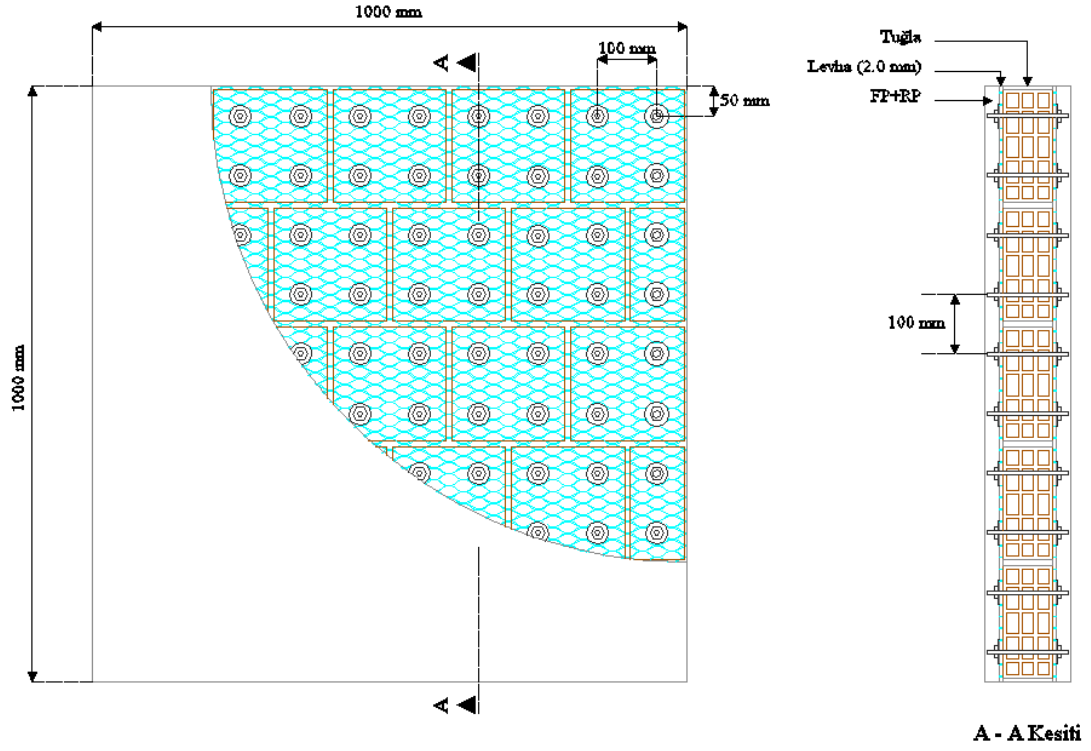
B1,5-100 deney elemanının boyutları ve güçlendirme detayları
